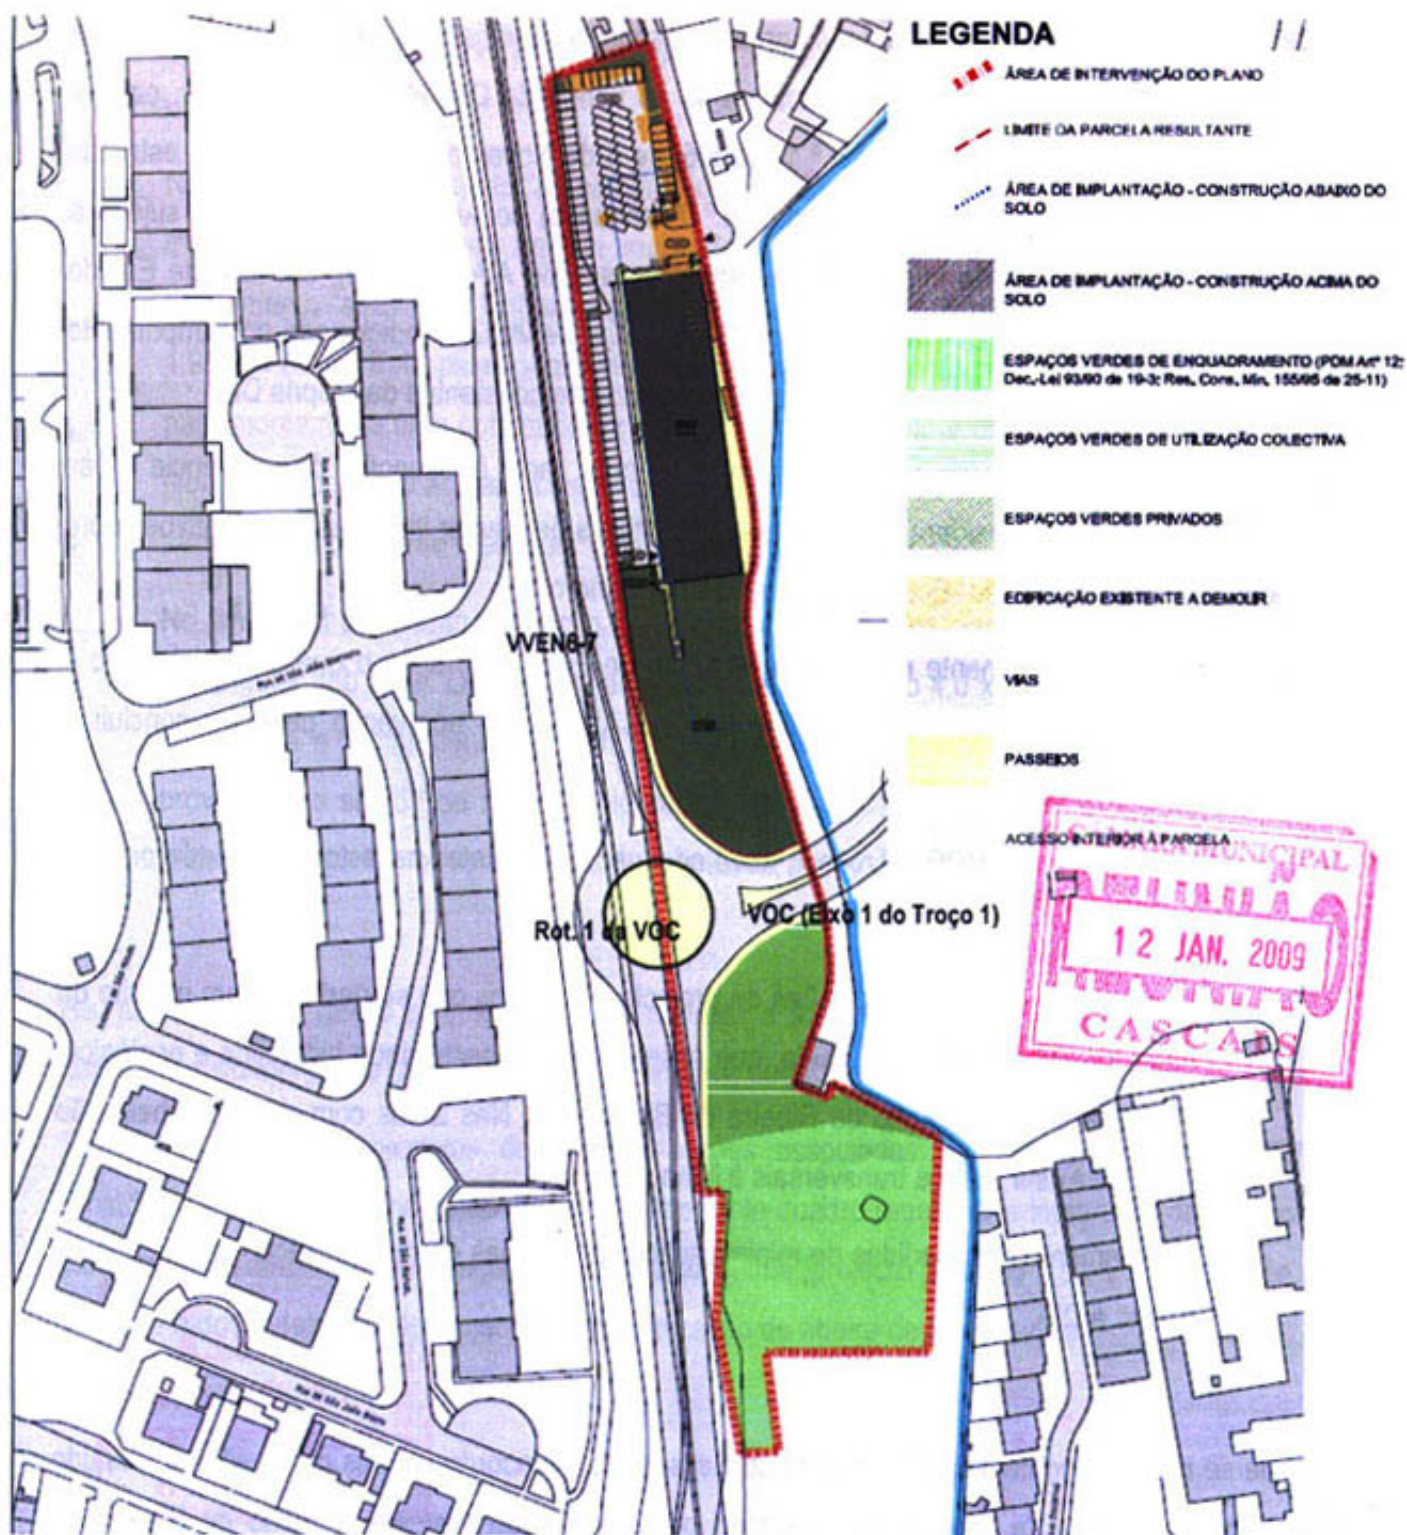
Planta de Zonamento proposta no PPETSN
